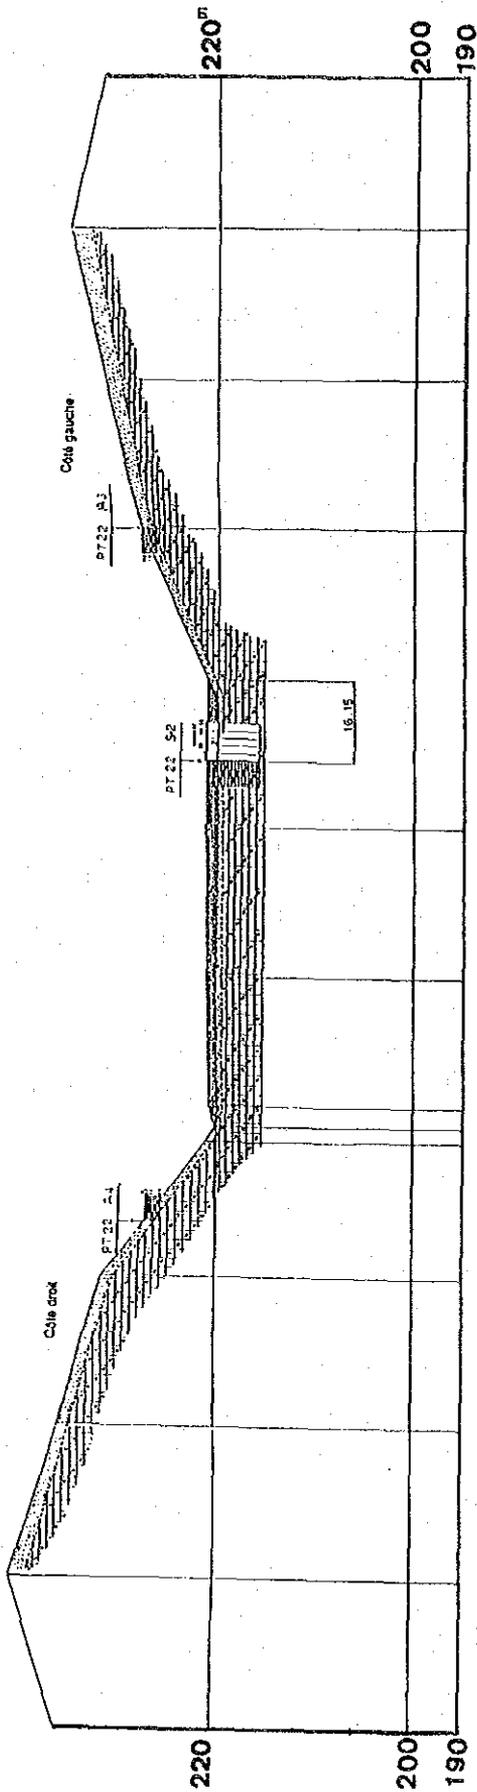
Coupe géologique du site du barrage P-T-22
